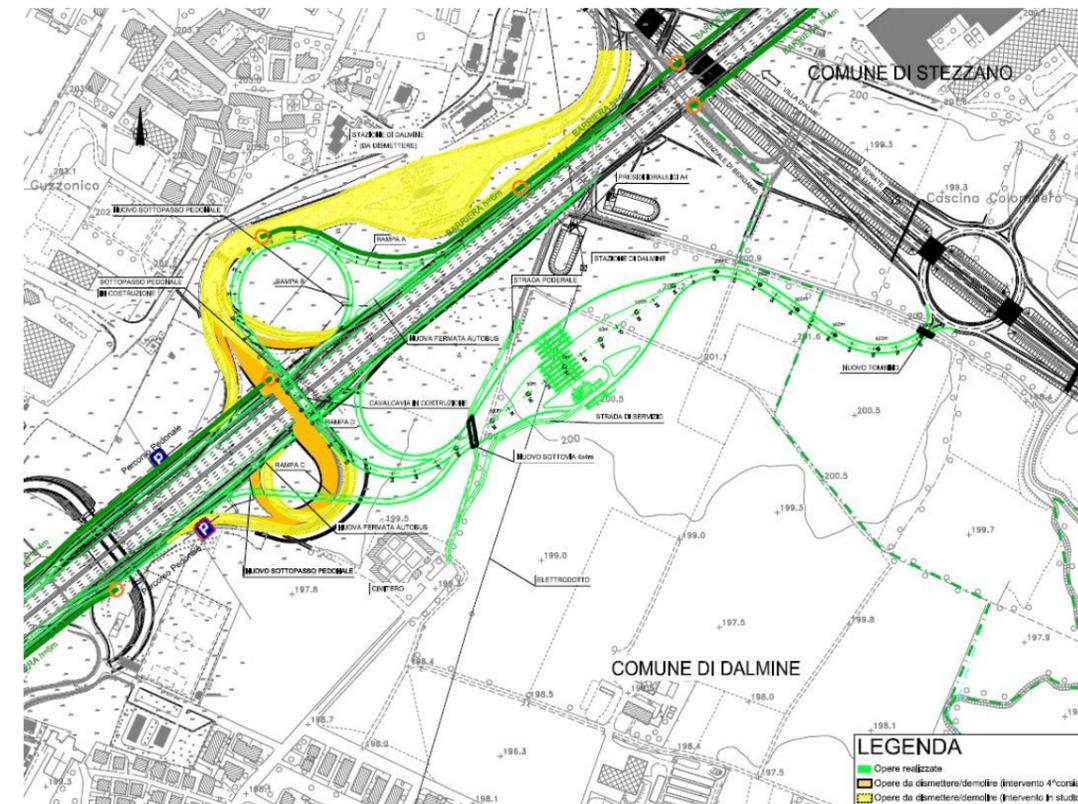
Planimetria Progetto È Progetto Preliminare 2006
